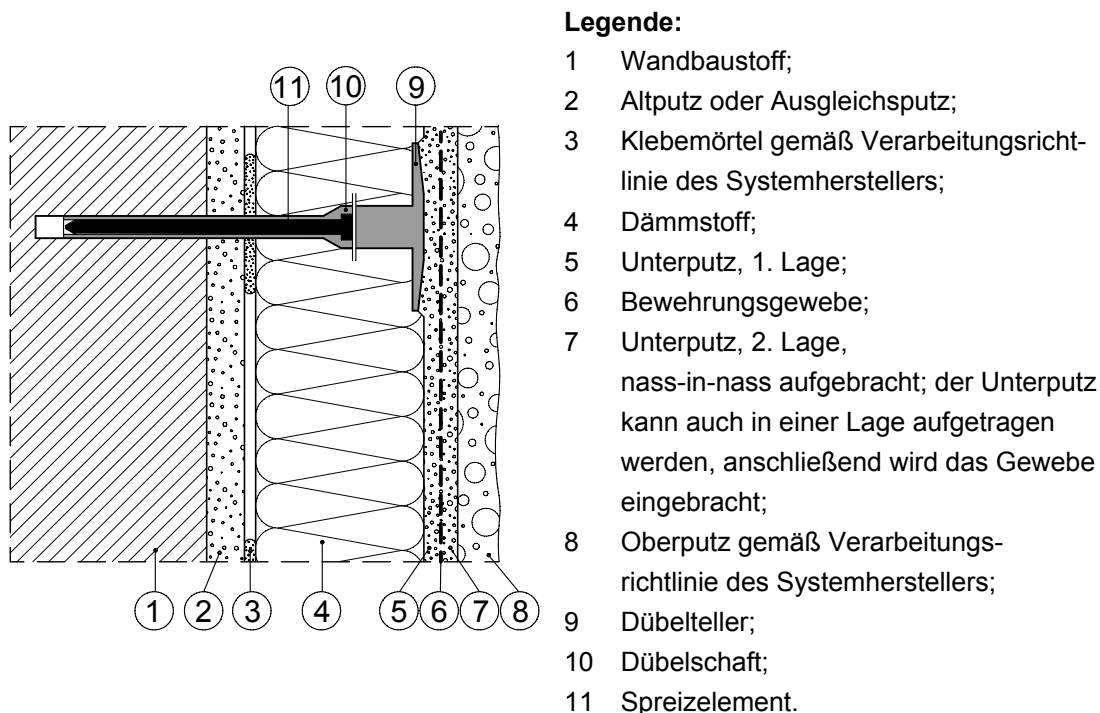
Aufbau eines WDVS mit Klebung und Dübelung, hier dargestellt mit Teilflächenverklebung am Untergrund und Dübelung unter dem Bewehrungsgewebe
